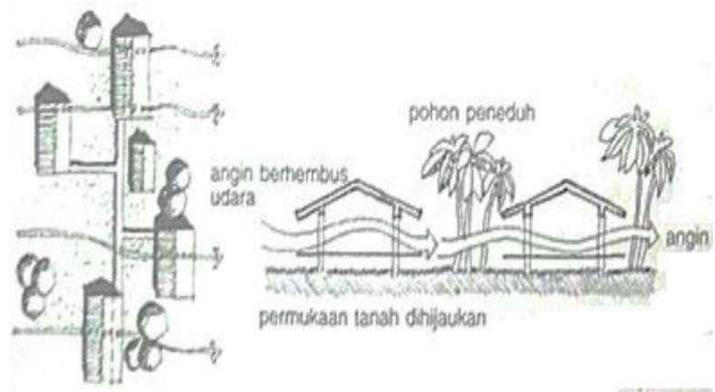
Penyusunan Struktur dan Konstruksi Bangunan
